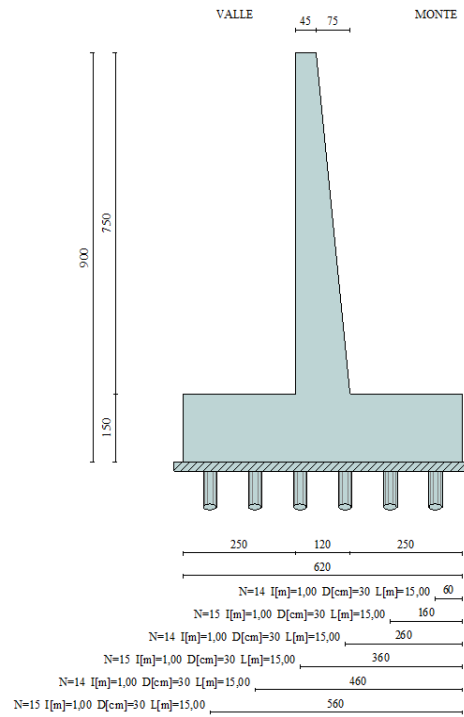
Muro Tipo A: geometria del muro di sostegno.
